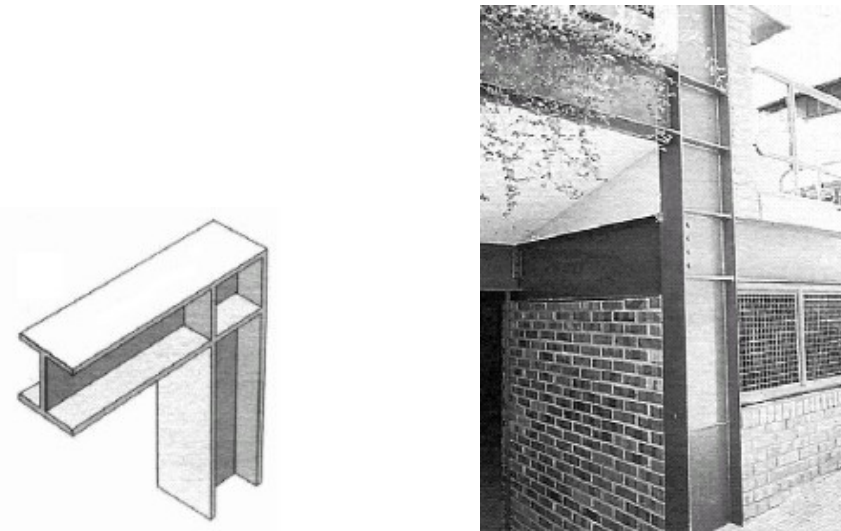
Exemplo de ligação rígida soldada entre viga e pilar.
